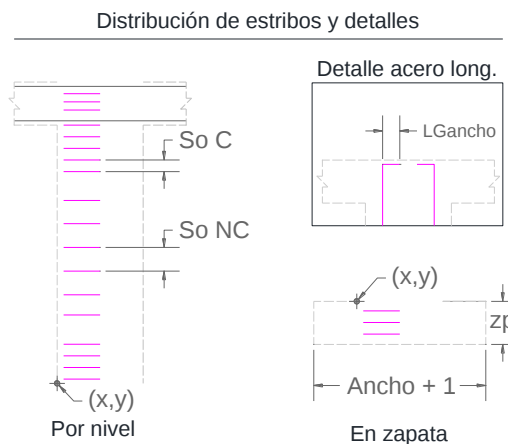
Detalle de separación de estribos y ganchos de acero longitudinal
